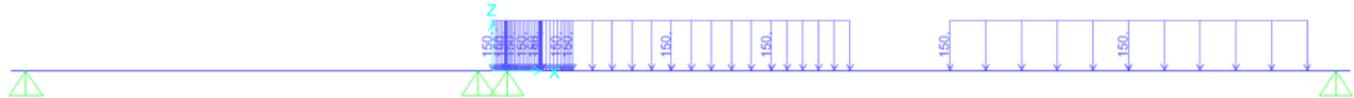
disposizione di carico 7 - SW/2 – pila 1
